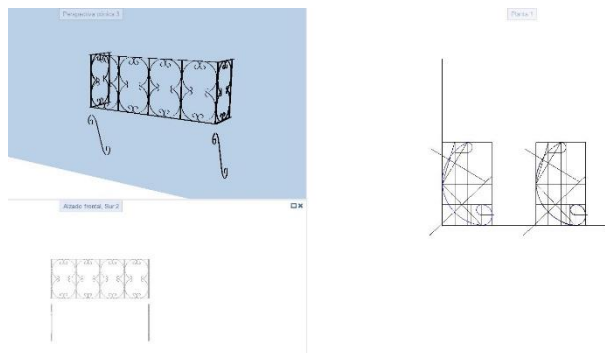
Balcón y detalles en forja. Fuente: Elaboración propia
